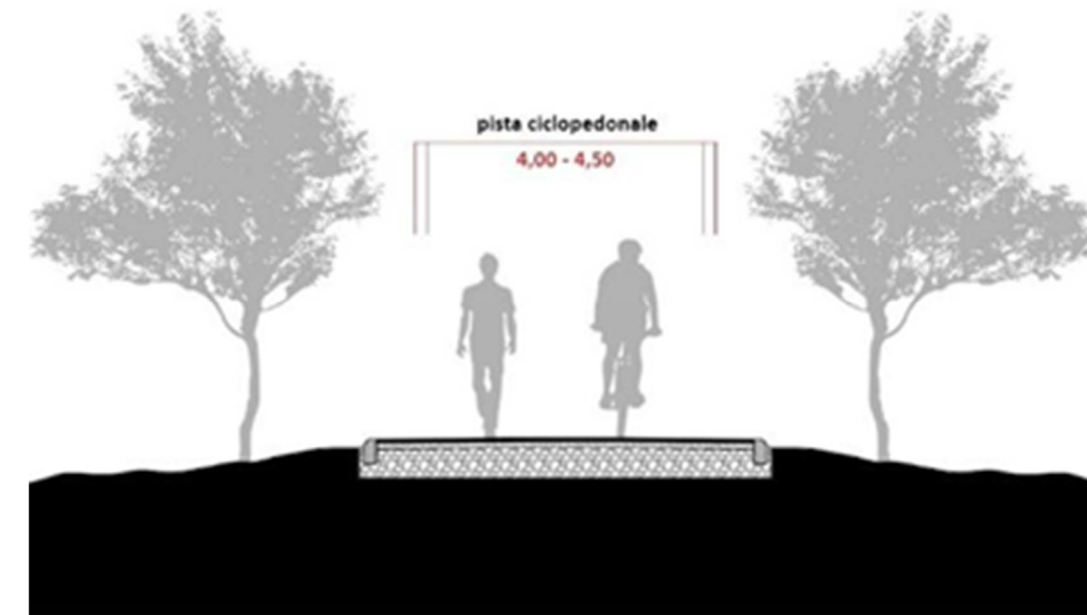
DETTAGLIO COSTRUTTIVO PISTA IN SEDE PROPRIA BIDIREZIONALE NON AFFIANCATA CICLOPEDONALE CON PAVIMENTAZIONE IN STABILIZZATO MISTO CAVA
